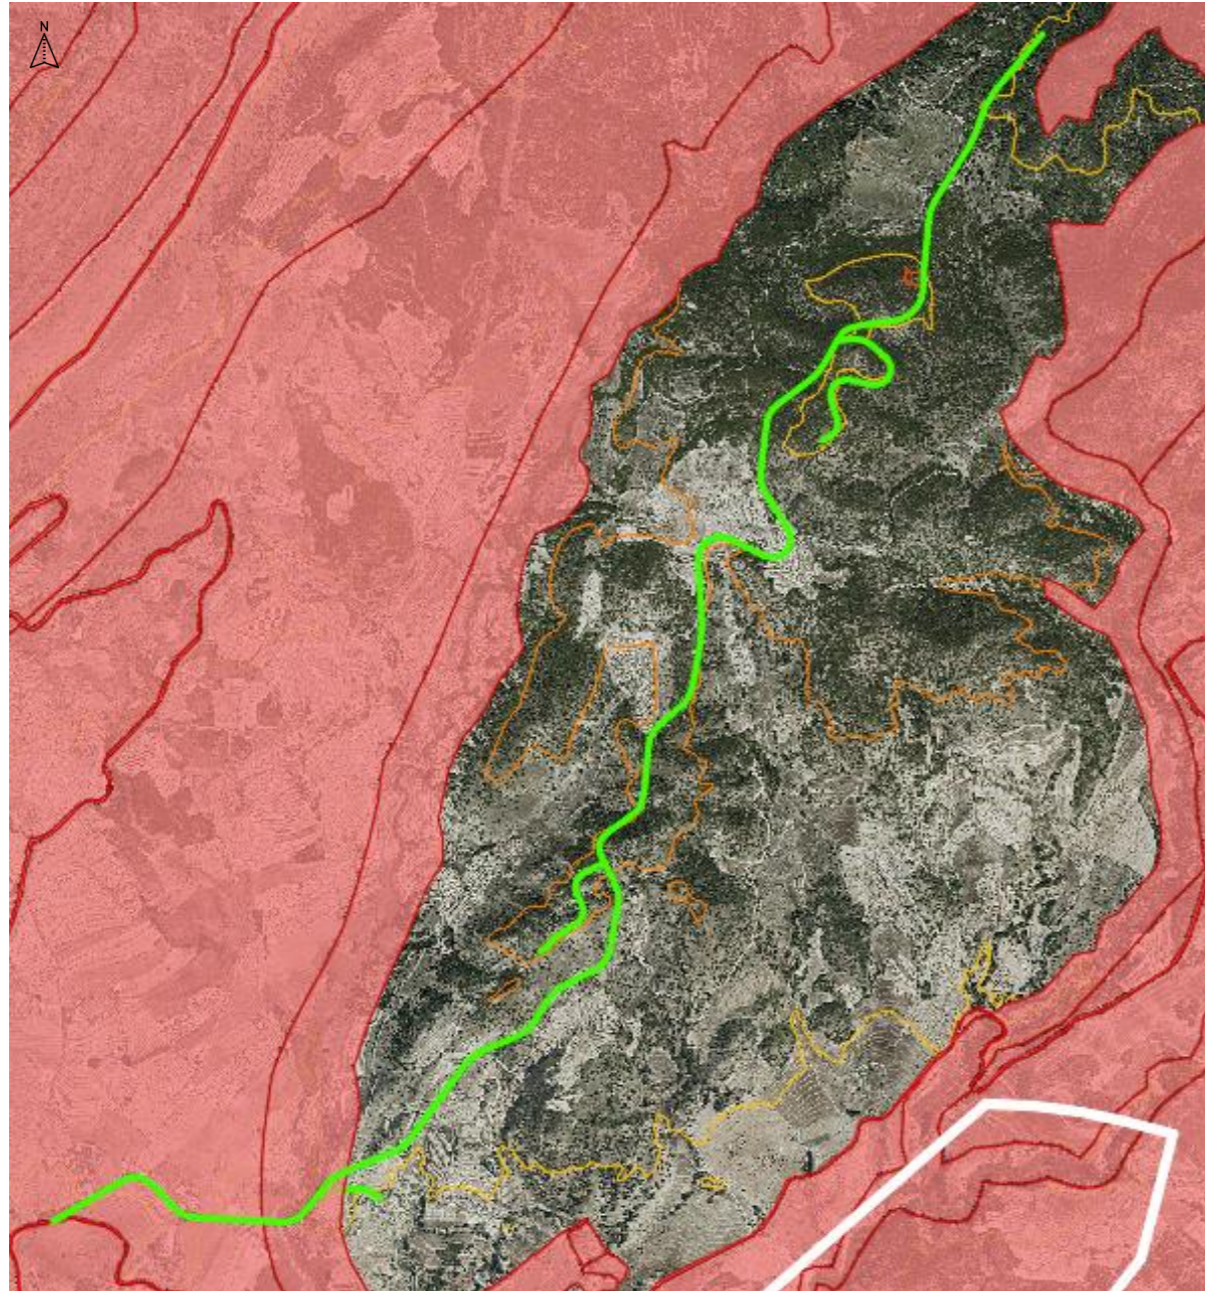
Trazado en planta de los viales que conforman el parque eólico de la Zona 14
